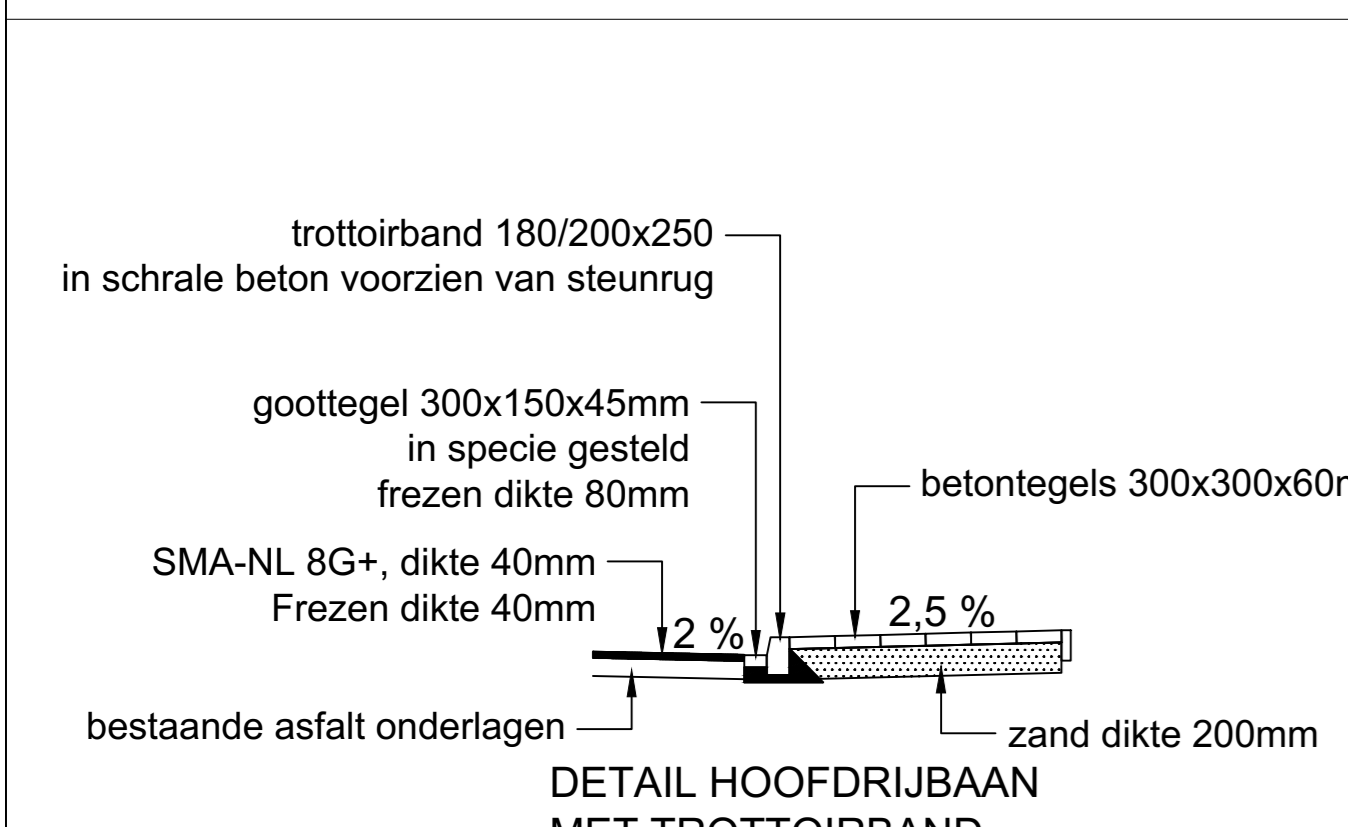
DETAIL HOOFDRIJBAAN MET TROTTOIRS
